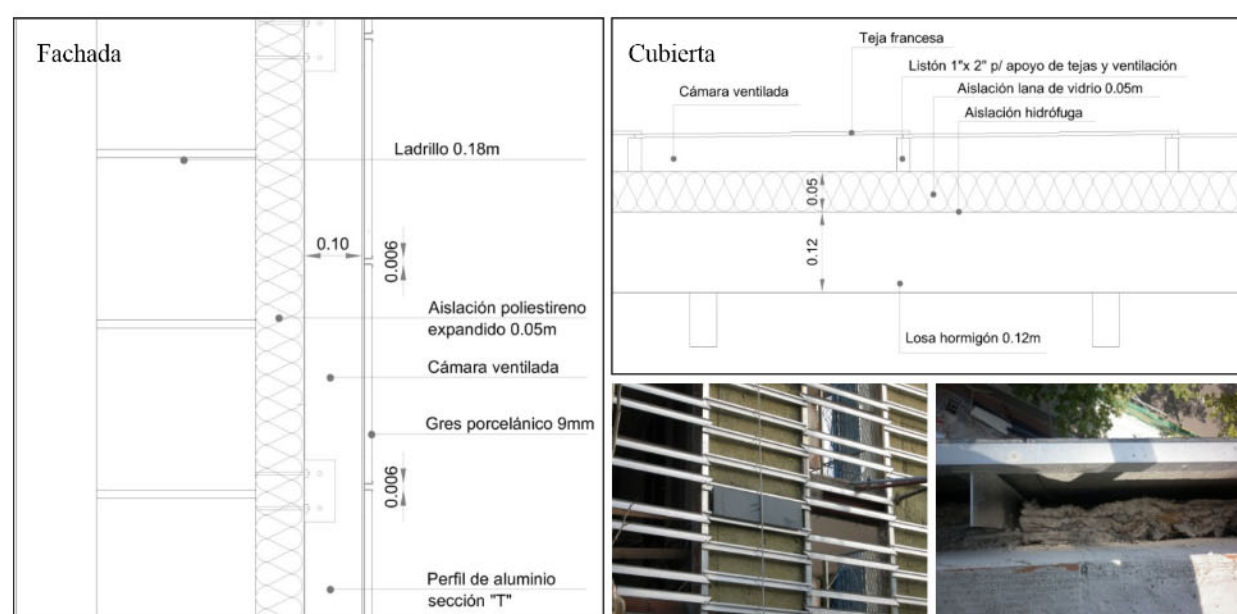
Detalle constructivo de ejemplos de envolventes ventiladas para fachada y cubierta e imágenes del sistema de fachada ventilada en construcción
